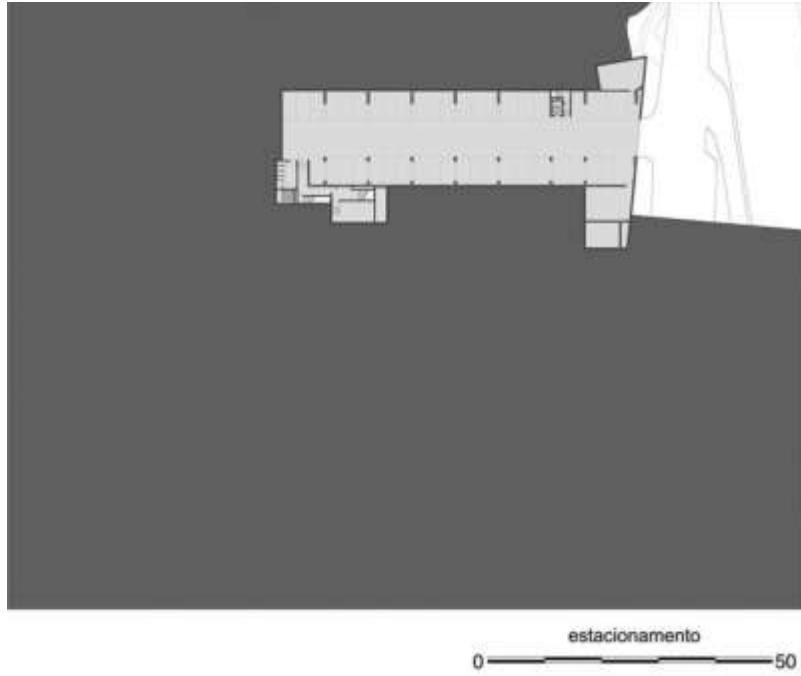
LUM. Planta del estacionamiento. Nivel -8,50 m. Estudio Barclay & Crousse
